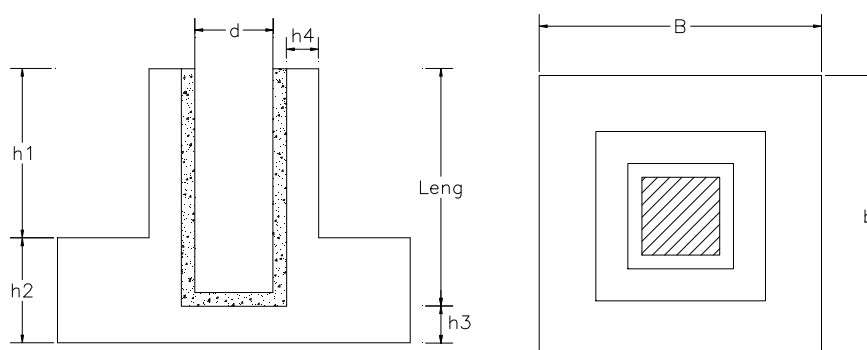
Ligação Rígida Tipo Cálice (Bucket Foundation)
